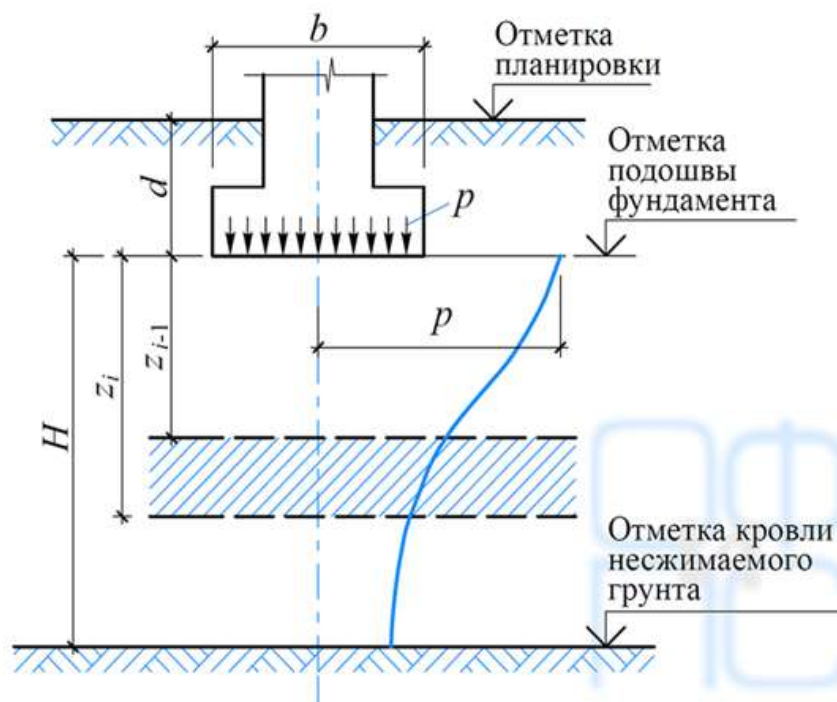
К расчету осадок с использованием расчетной схемы линейно-деформируемого слоя
